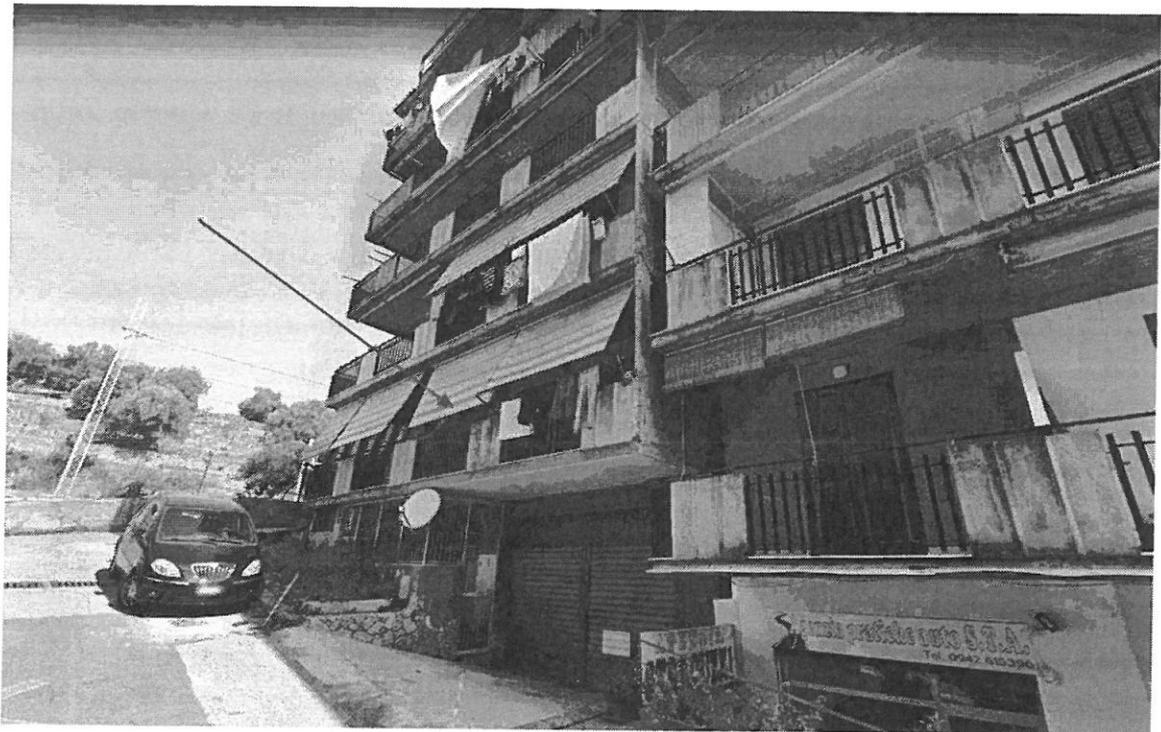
Prospetto SUD-OVEST via Umberto I
